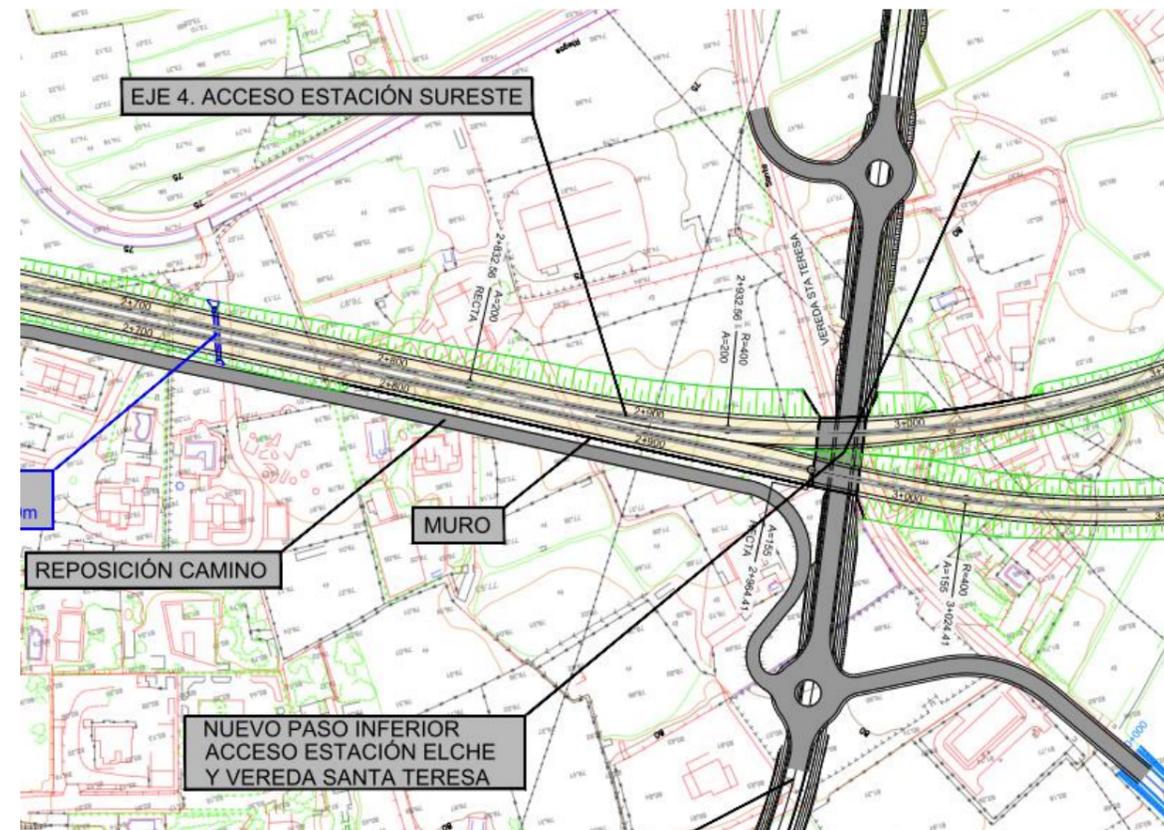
ACCESO ESTACIÓN. REPOSICIÓN PLANTEADA. ALTERNATIVA 1
